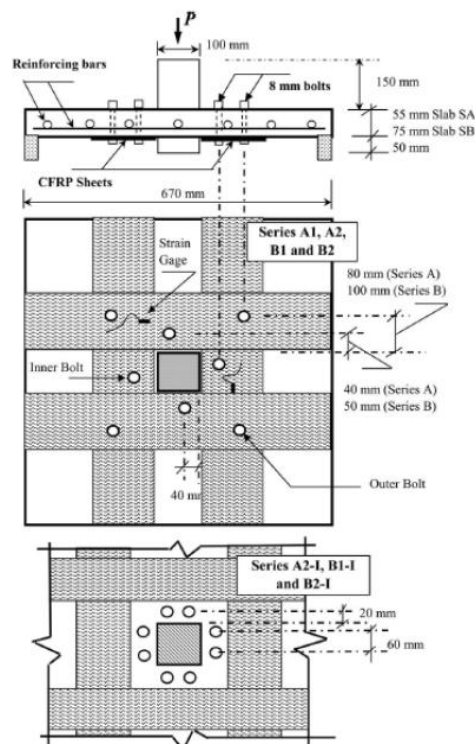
Definição geométrica e pormenorização do reforço das lajes [17]
